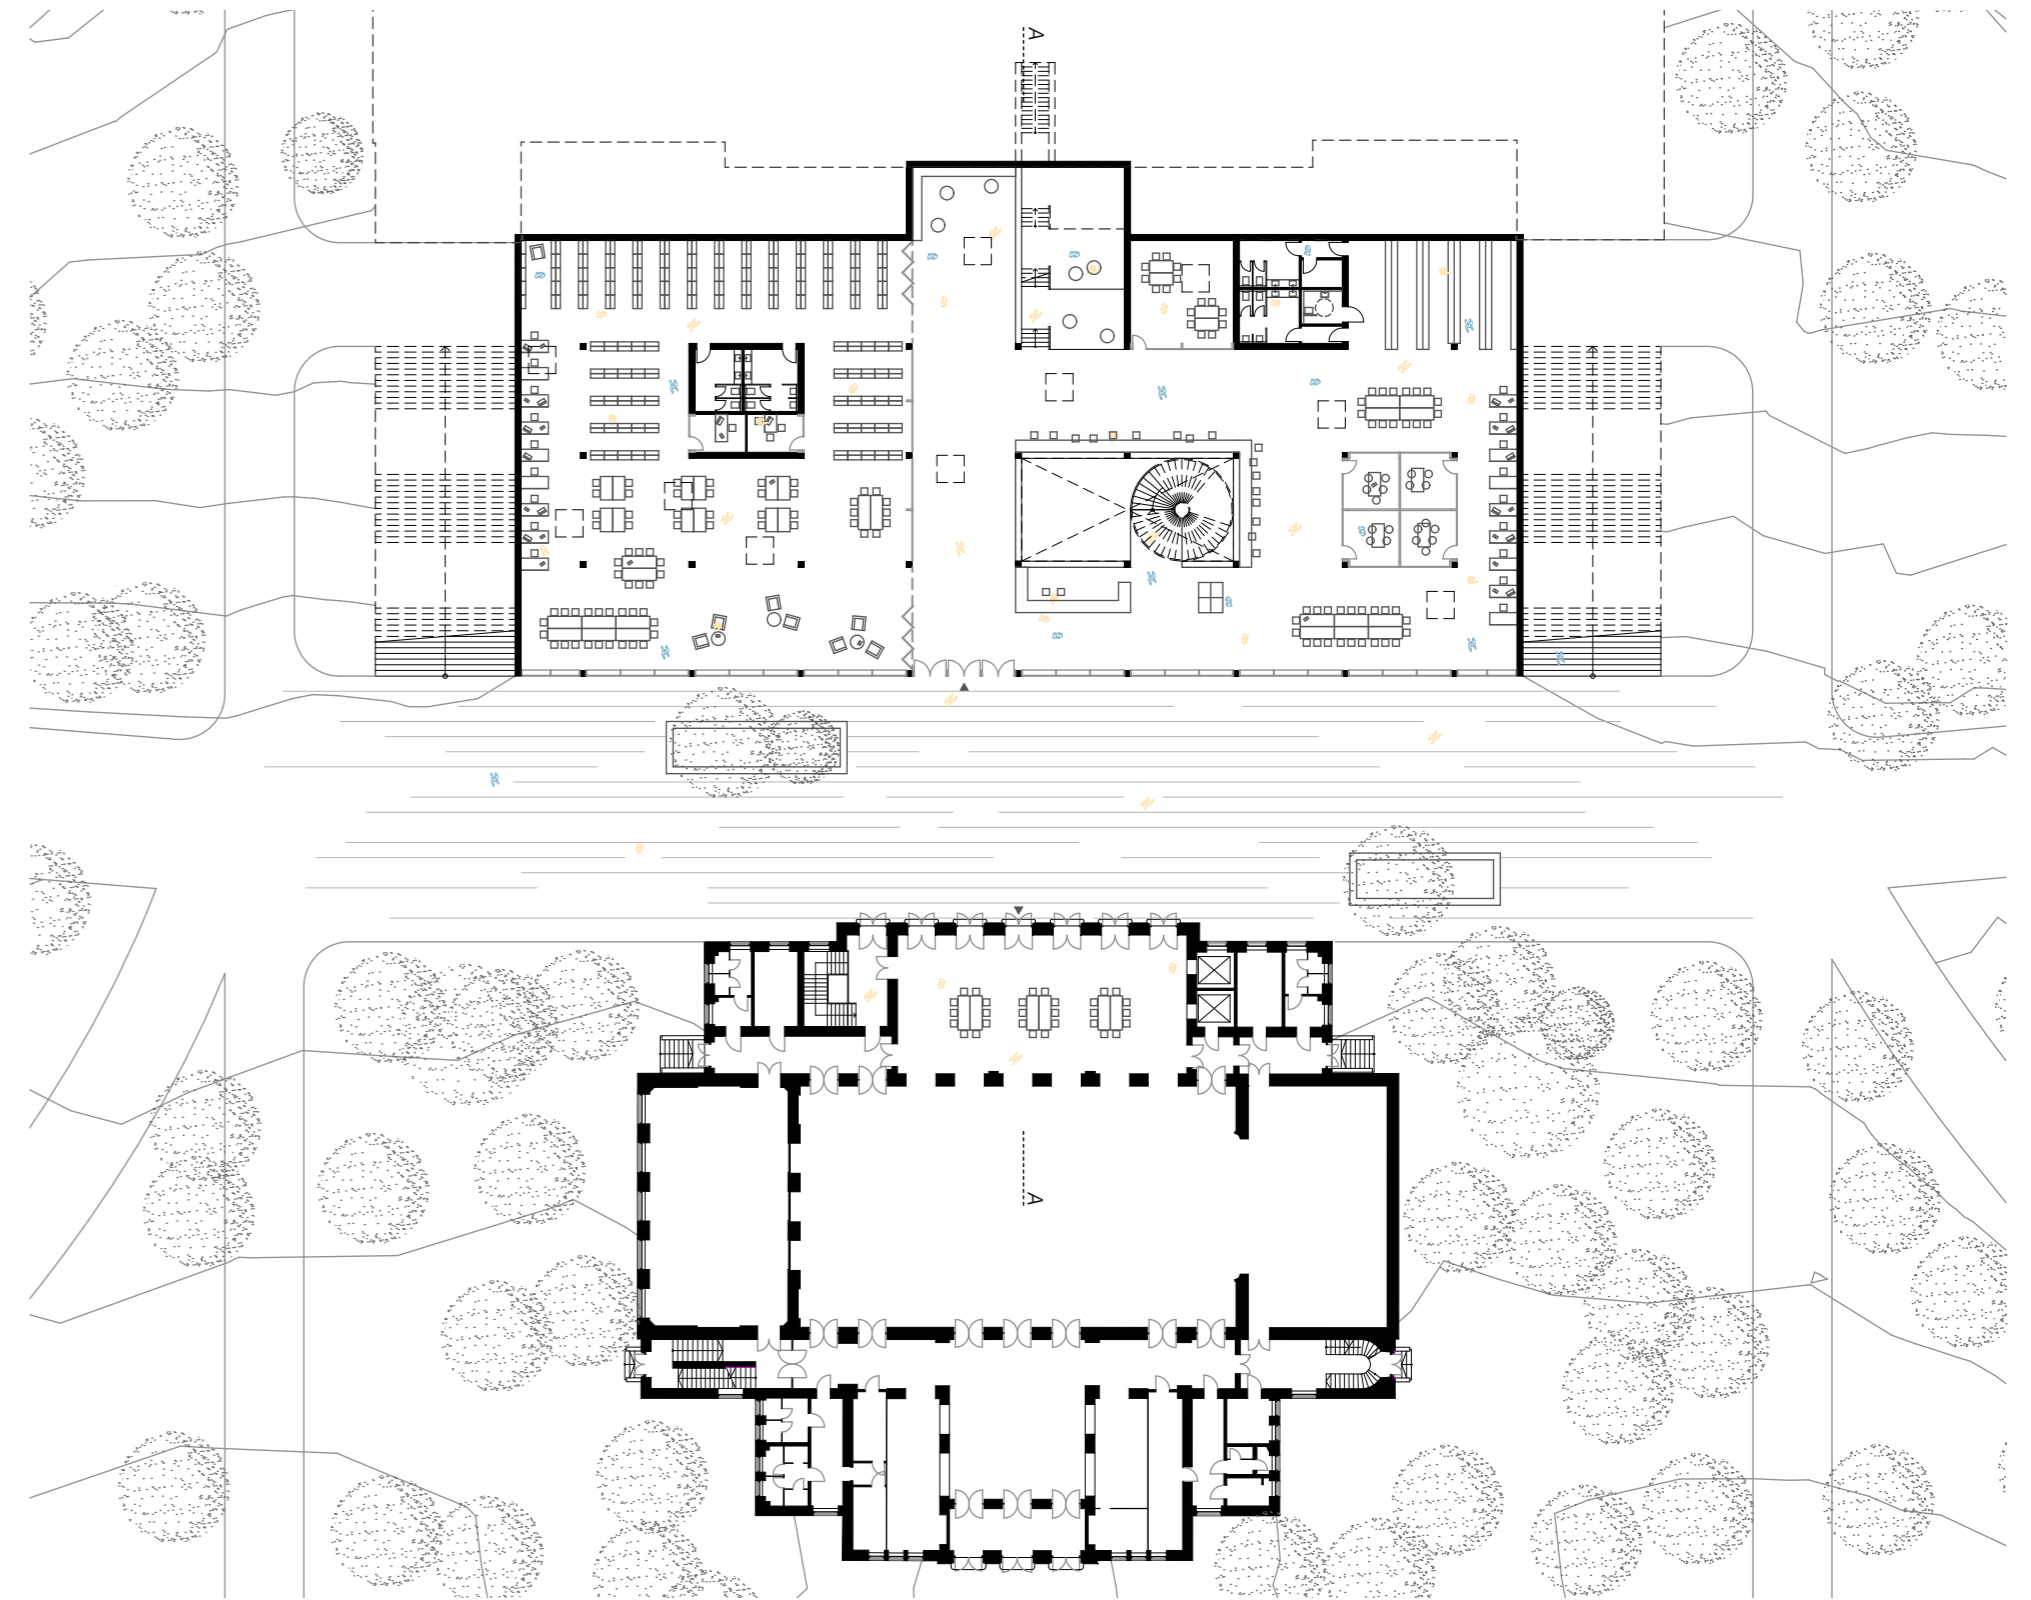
Grundriss | Erdgeschoss | M 1-500
